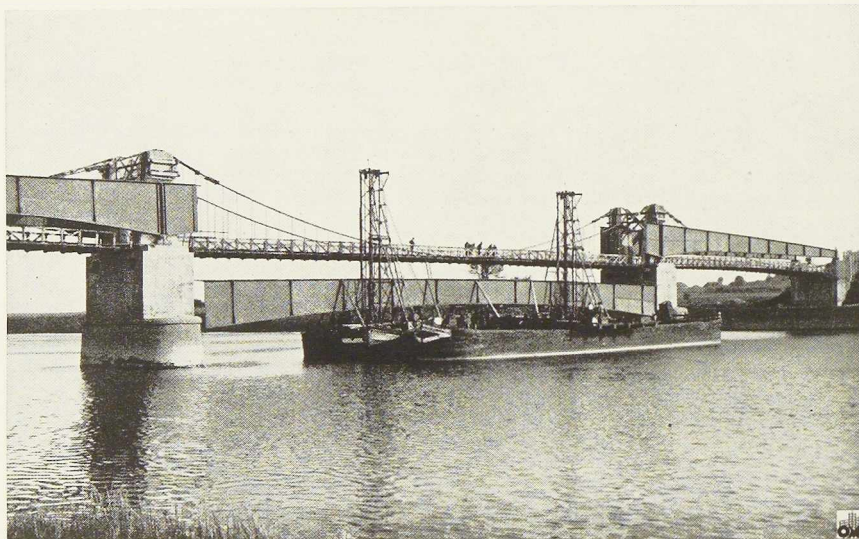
Montage de la travée centrale. On aperçoit à l'arrière-plan le vieux pont suspendu resté en service pendant la construction du nouveau pont.
